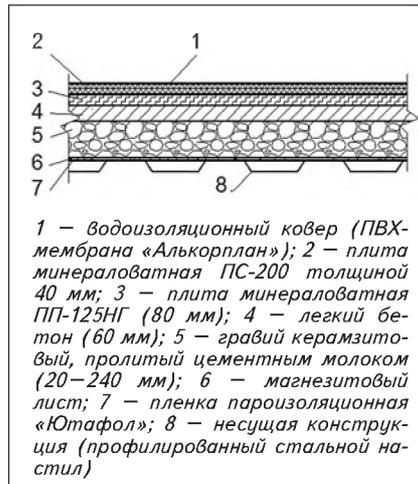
Конструкция совмещенного покрытия здания супермаркета «Мікс» (г. Брест)
